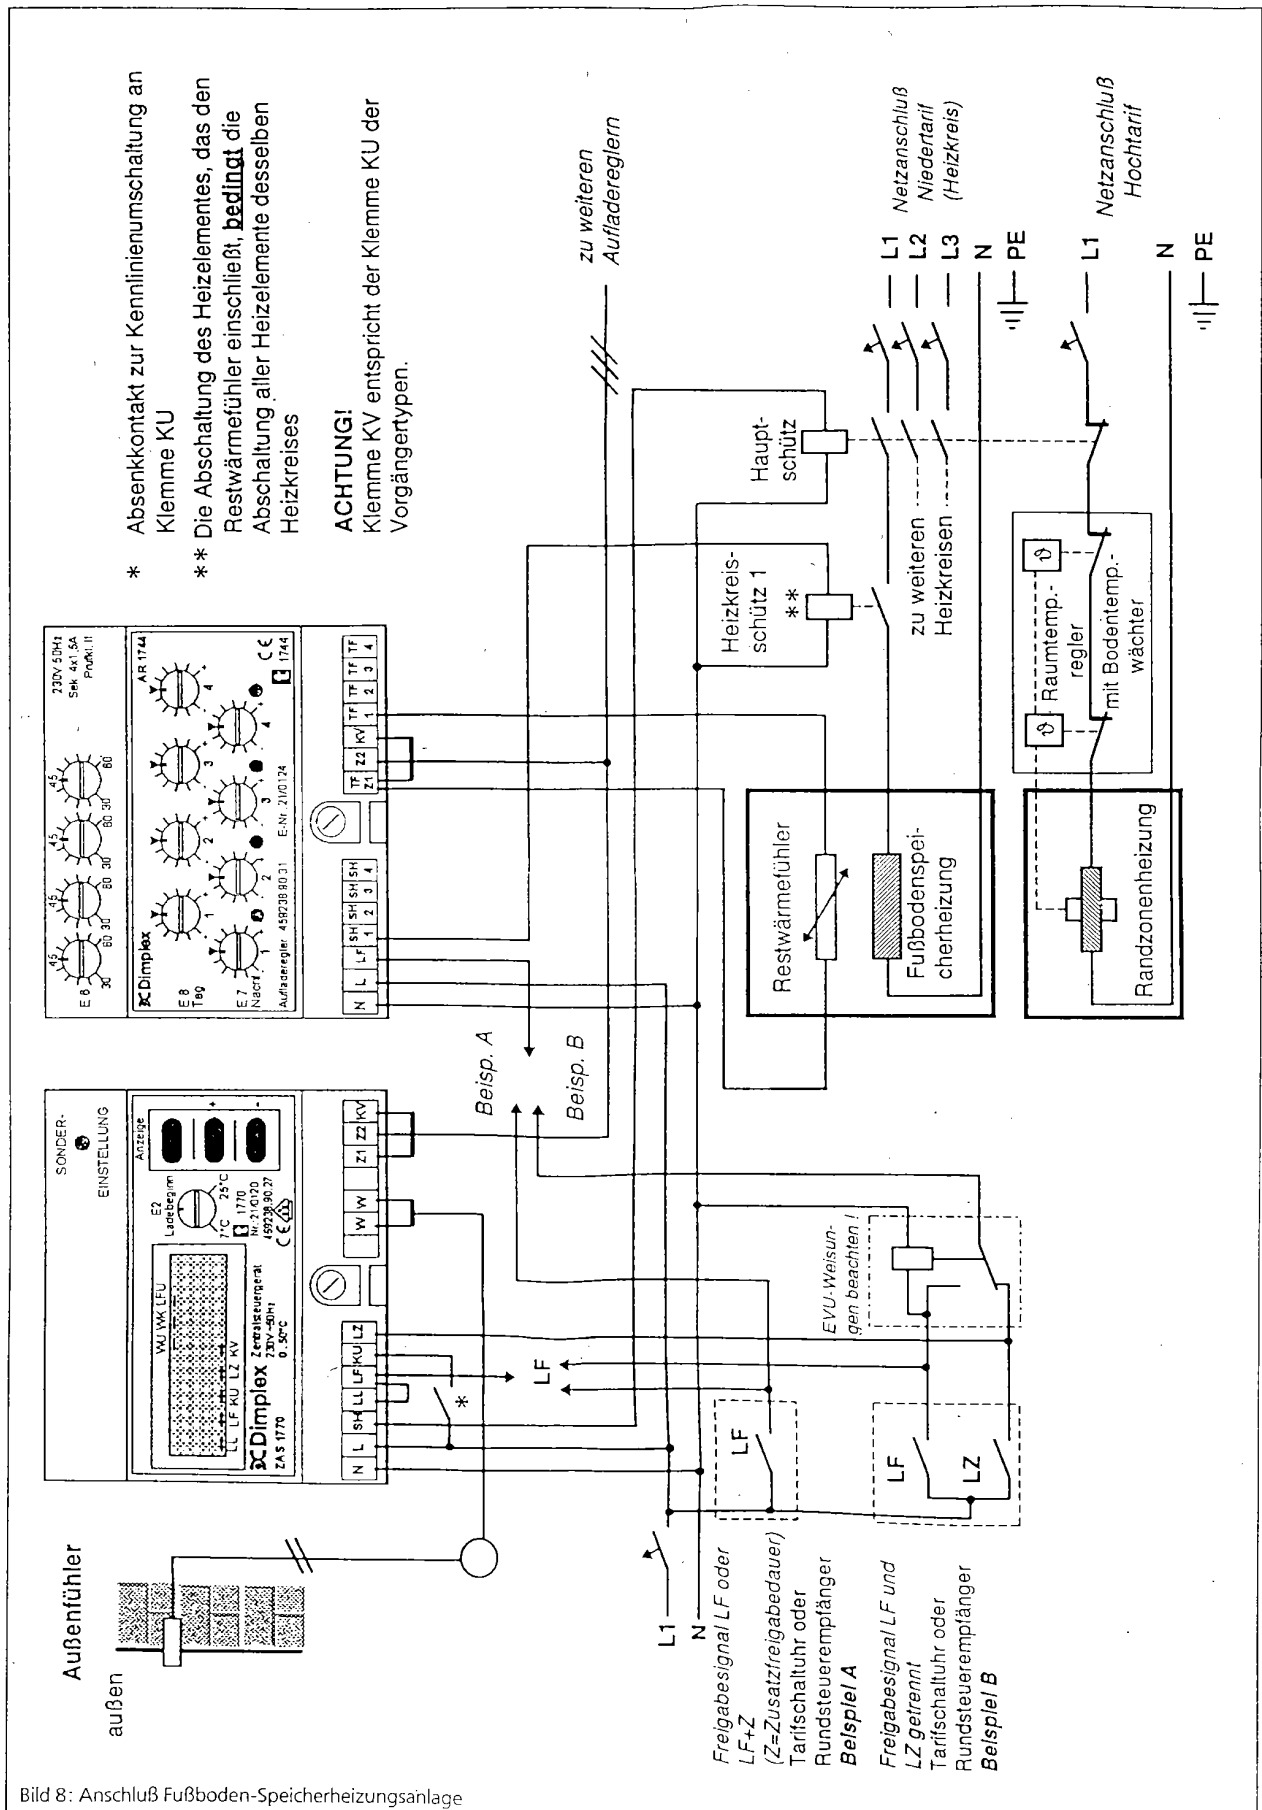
Anschluß Fußboden-Speicherheizungsanlage
